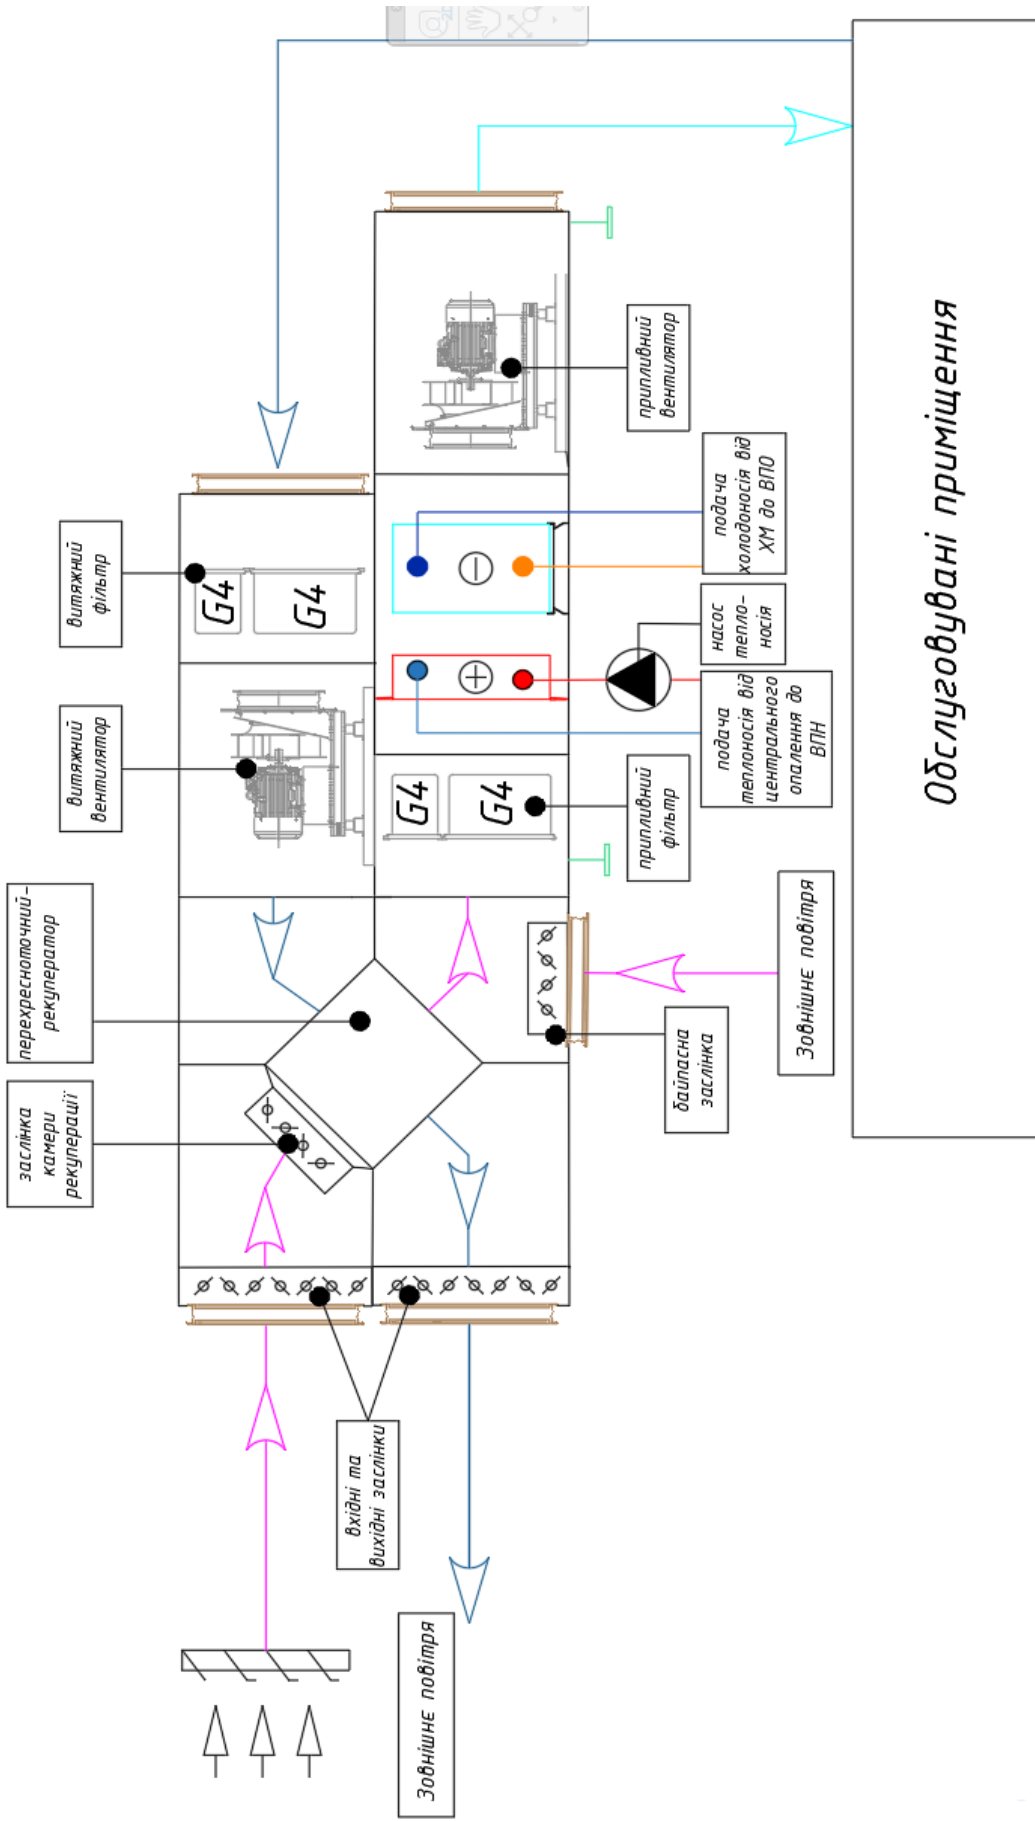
Принципова схема припливно-втяжної установки з рекуператором
